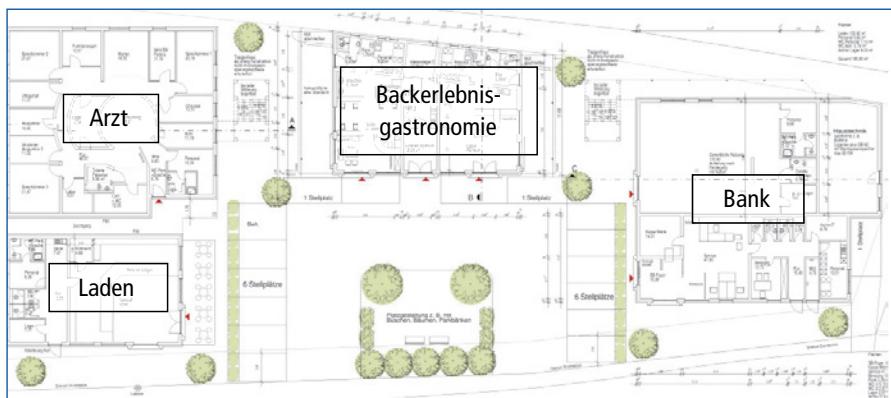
Erdgeschossgrundrisse der Gebäude des »Dorfcenters«
